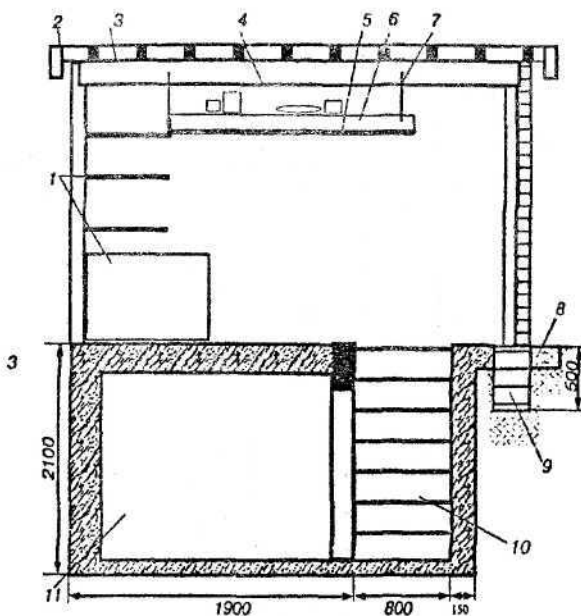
Оборудование гаража и поперечный разрез со смотровой ямой и подвалом:
